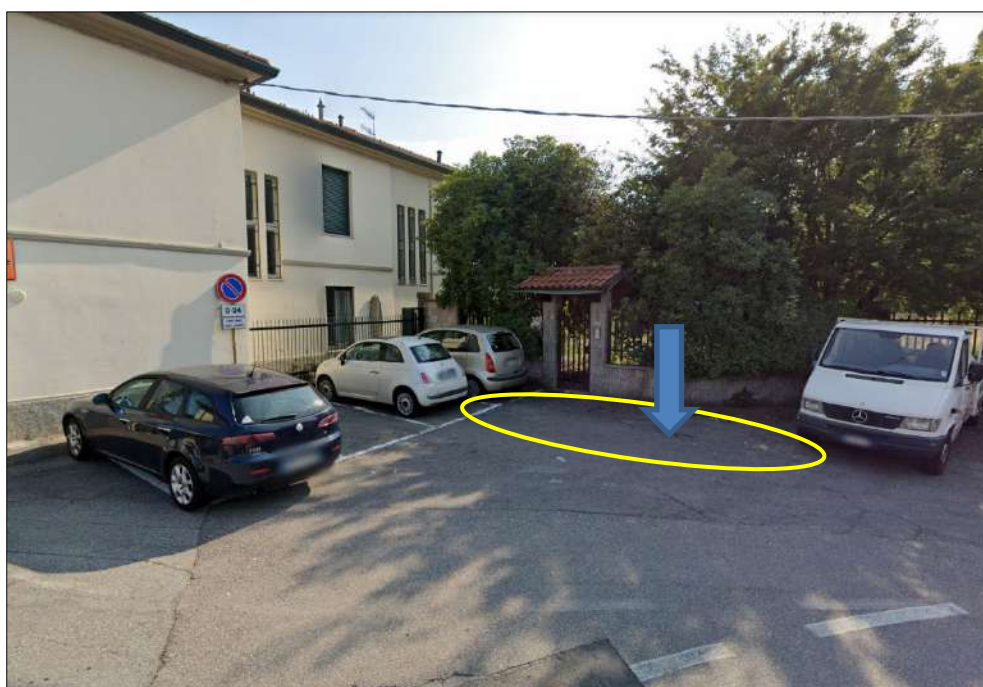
Piazza Monte Rosa - Area perforazione piezometro PZ12
